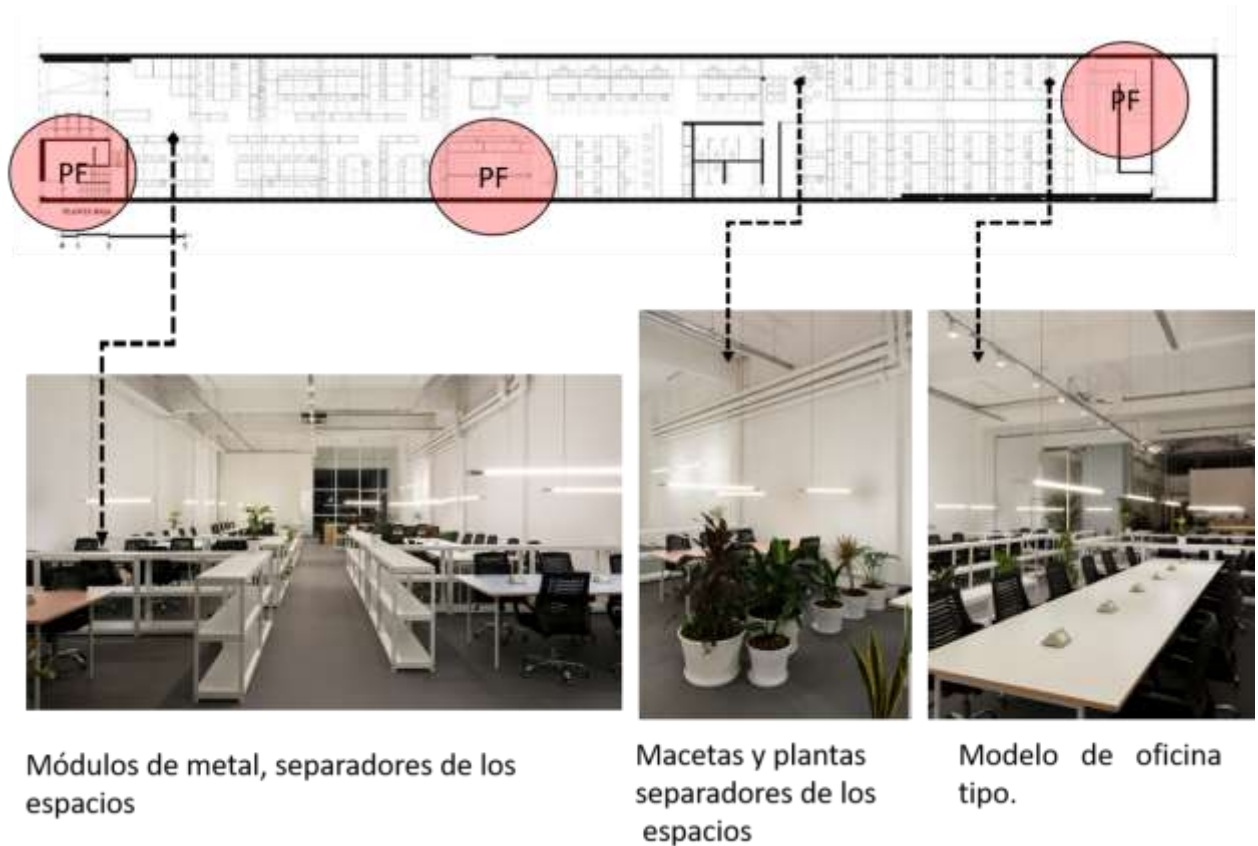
Planta e imágenes de la planta baja cowork la Huerta.
